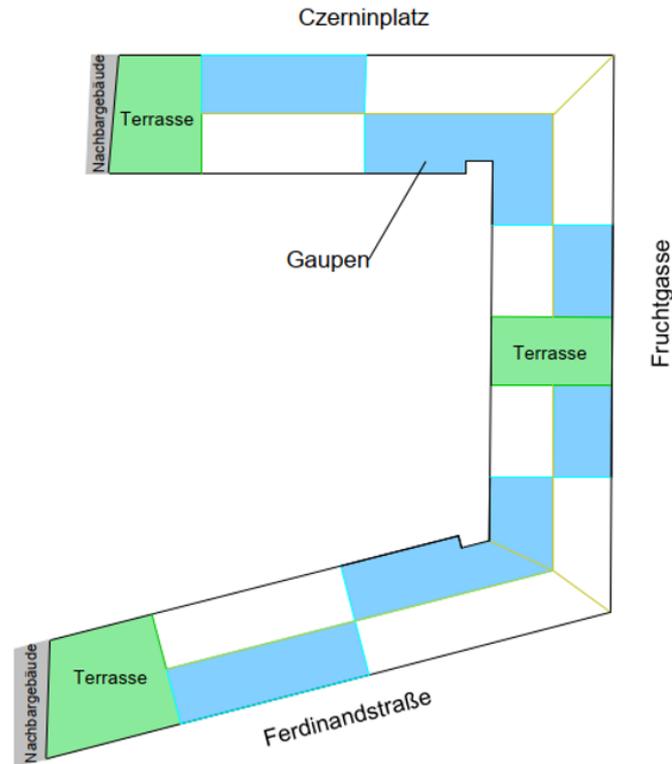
Czerninplatz 7 - Grundriss Anordnung Gaupen einseitig
